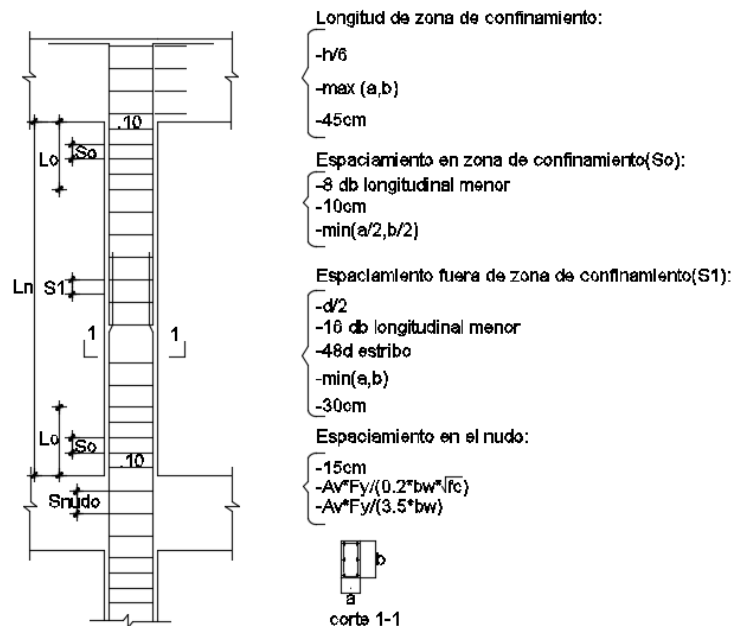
Detalles de espaciamiento de estribos de la columna (Norma E.060)
